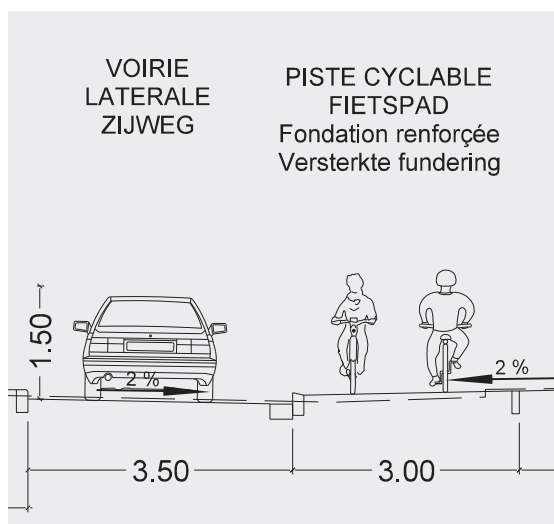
Boulevard Baudouin/Boulevard d'Anvers – Coupe transversale d'une piste cyclable avec bordure asymétrique.
